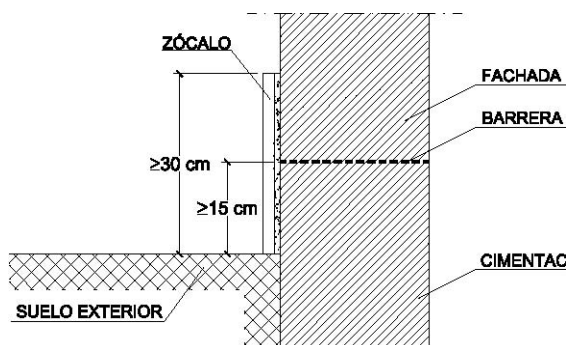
Ejemplo de arranque de la fachada desde la cimentación
